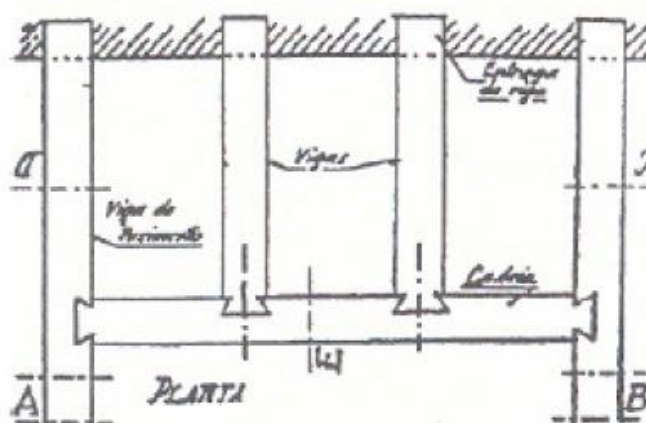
Cadeia em planta (Oliveira, 2013)
